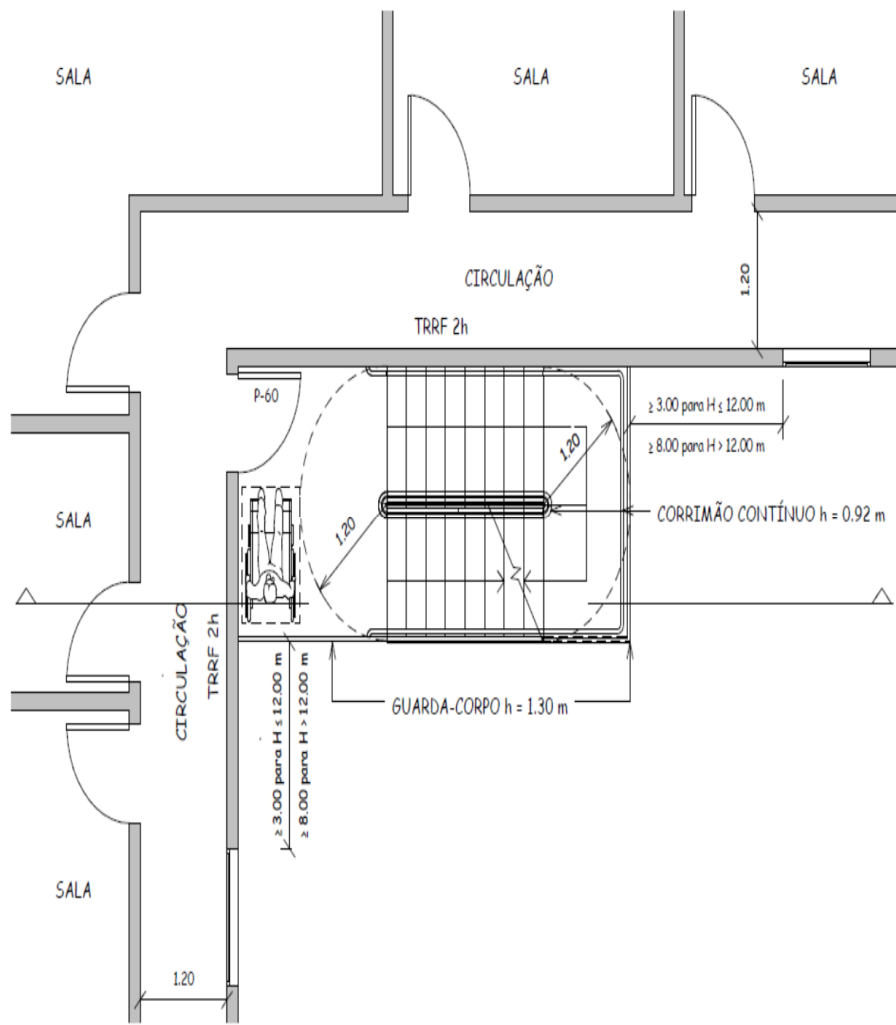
B - Escada aberta externa - pavimento intermediário (planta baixa).
